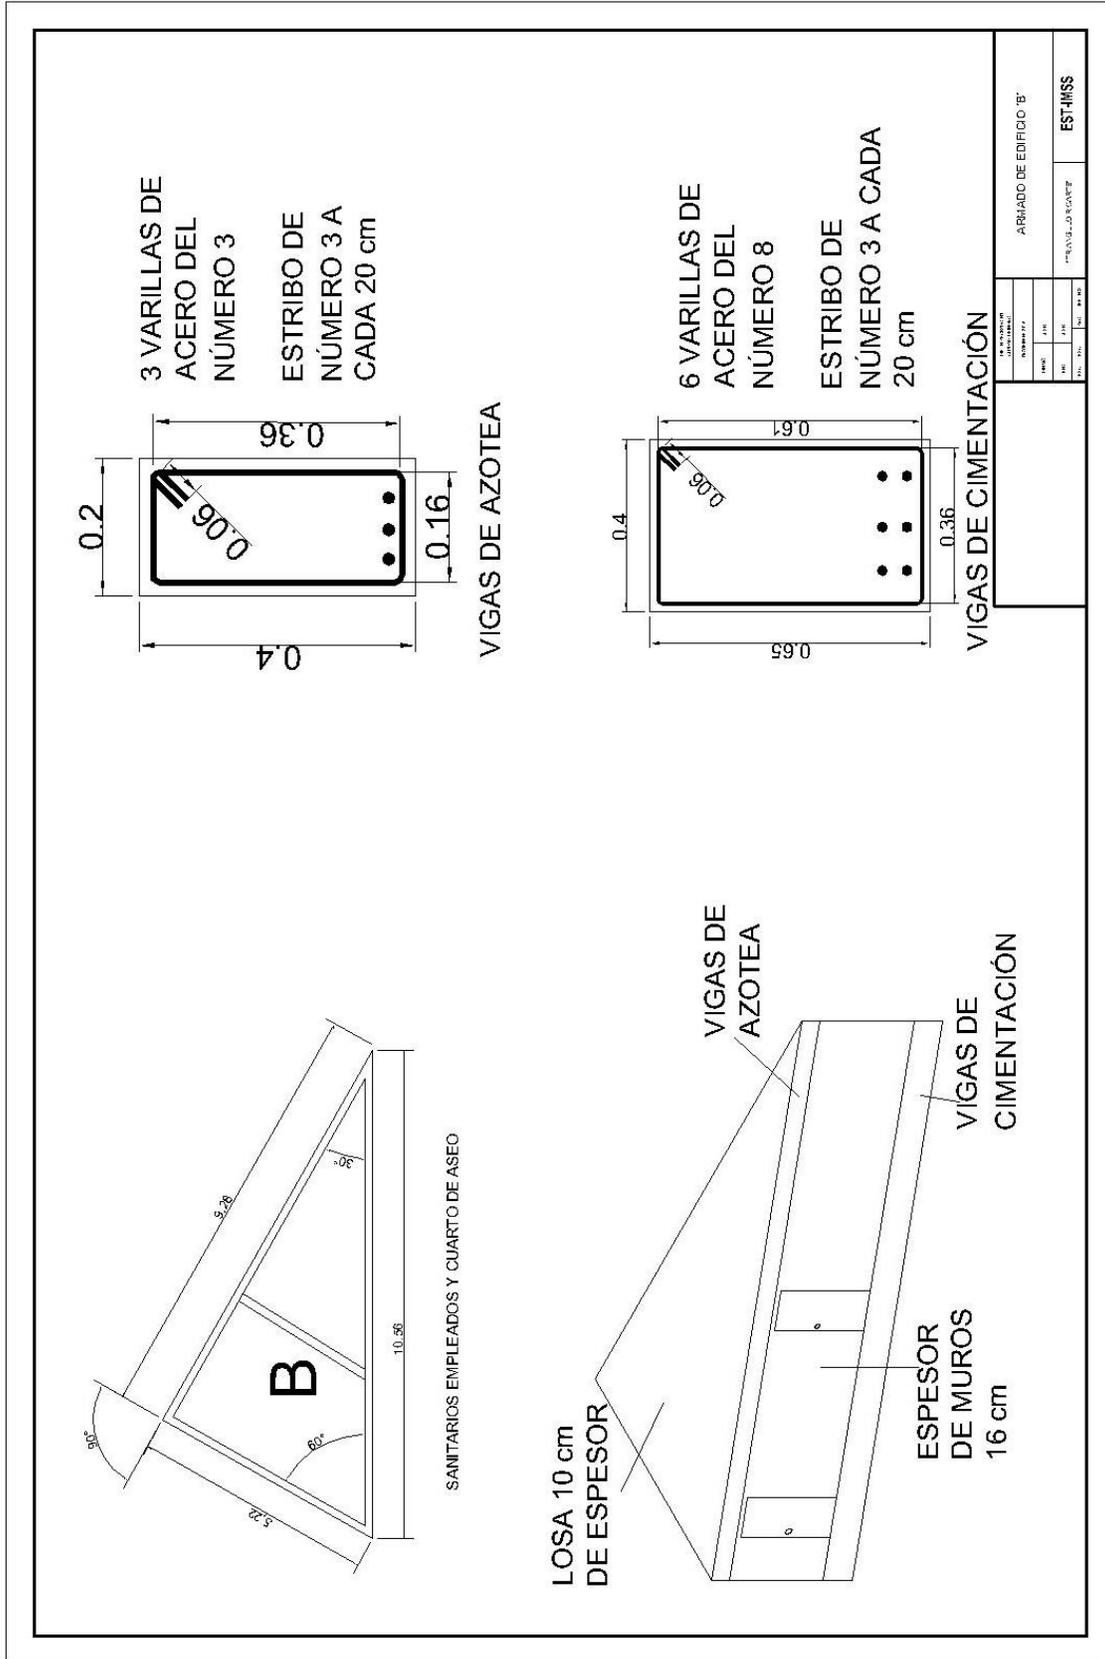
Plano de vigas de edificio "B" (fuente: dibujo hecho por el autor).
